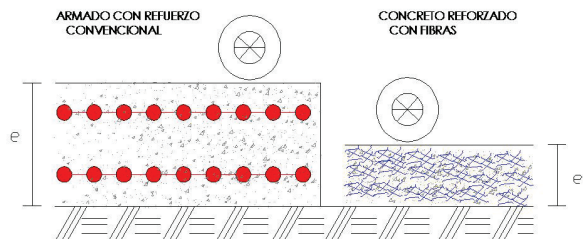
Utilizando fibras de acero Ramgra® puede reducir el espesor de un piso de concreto en comparación con un piso
